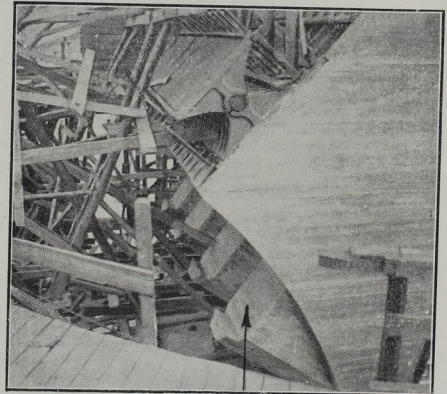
Premier étape après construction de la pile, mise en place et fixation des rotules de pied des arches (vue de face et de haut). On voit les sommiers en béton pour l'appui des cintres
